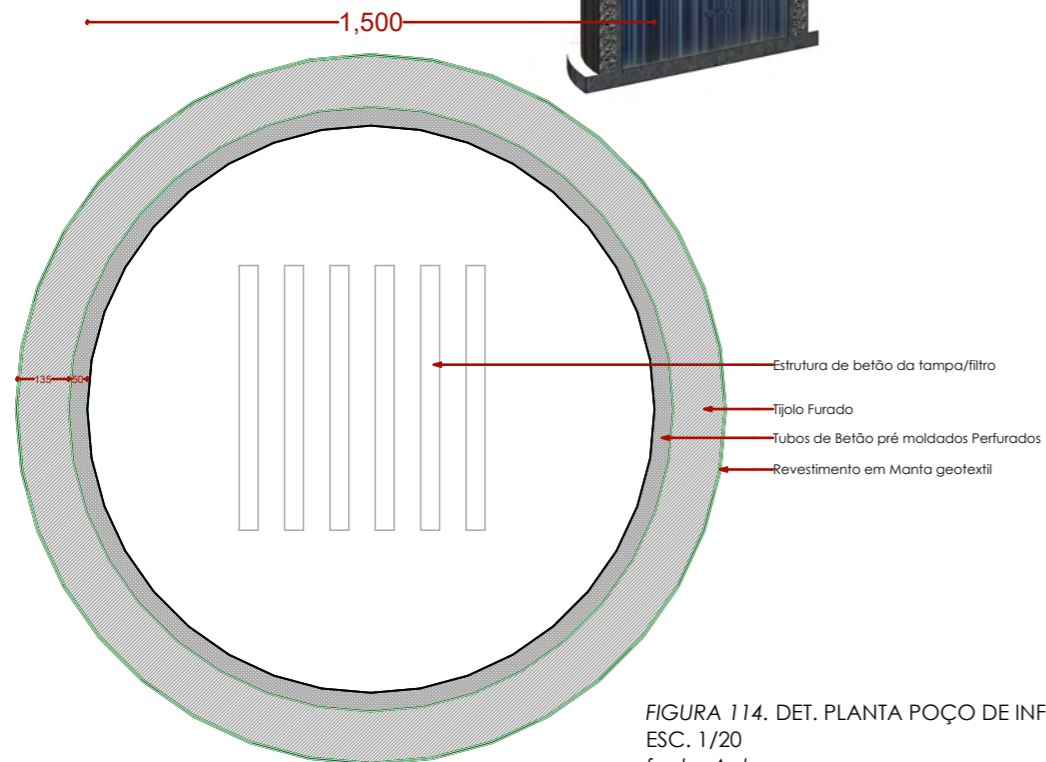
DET. PLANTA POÇO DE INFILTRAÇÃO
